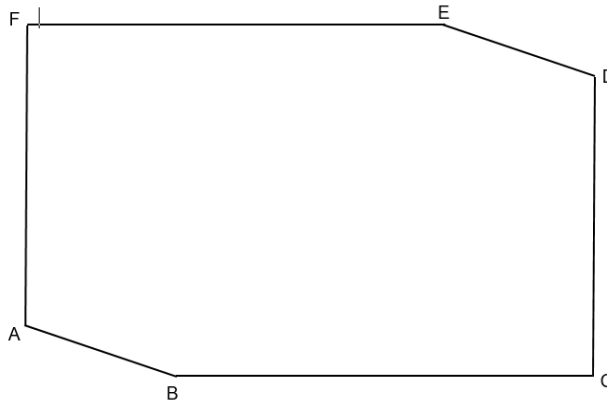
Streitbetroffenes Projekt. Schematische Darstellung der für die Grenzabstände massgebenden Fassaden im Grundriss
